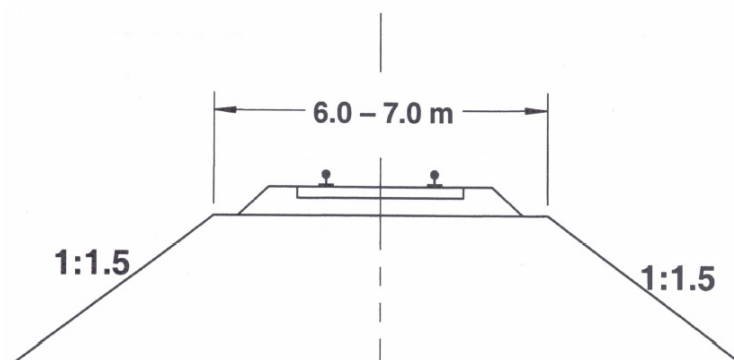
Perfil típico de um aterro junto ao encontro da ponte numa linha férrea recentemente construída (ERRI, 1999)
